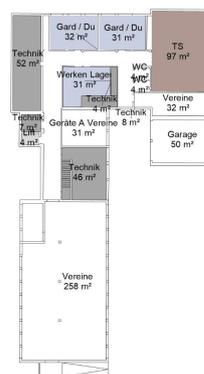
Untergeschoss Turnhalle, Variante «violett»
